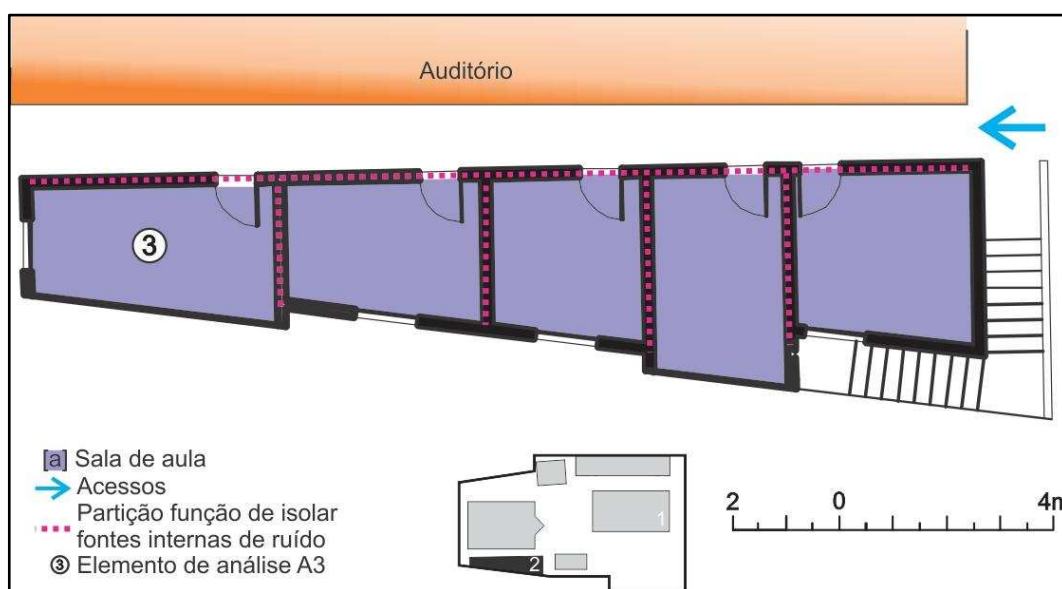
Configuração do Anexo2 da Unidade B em planta baixa.
